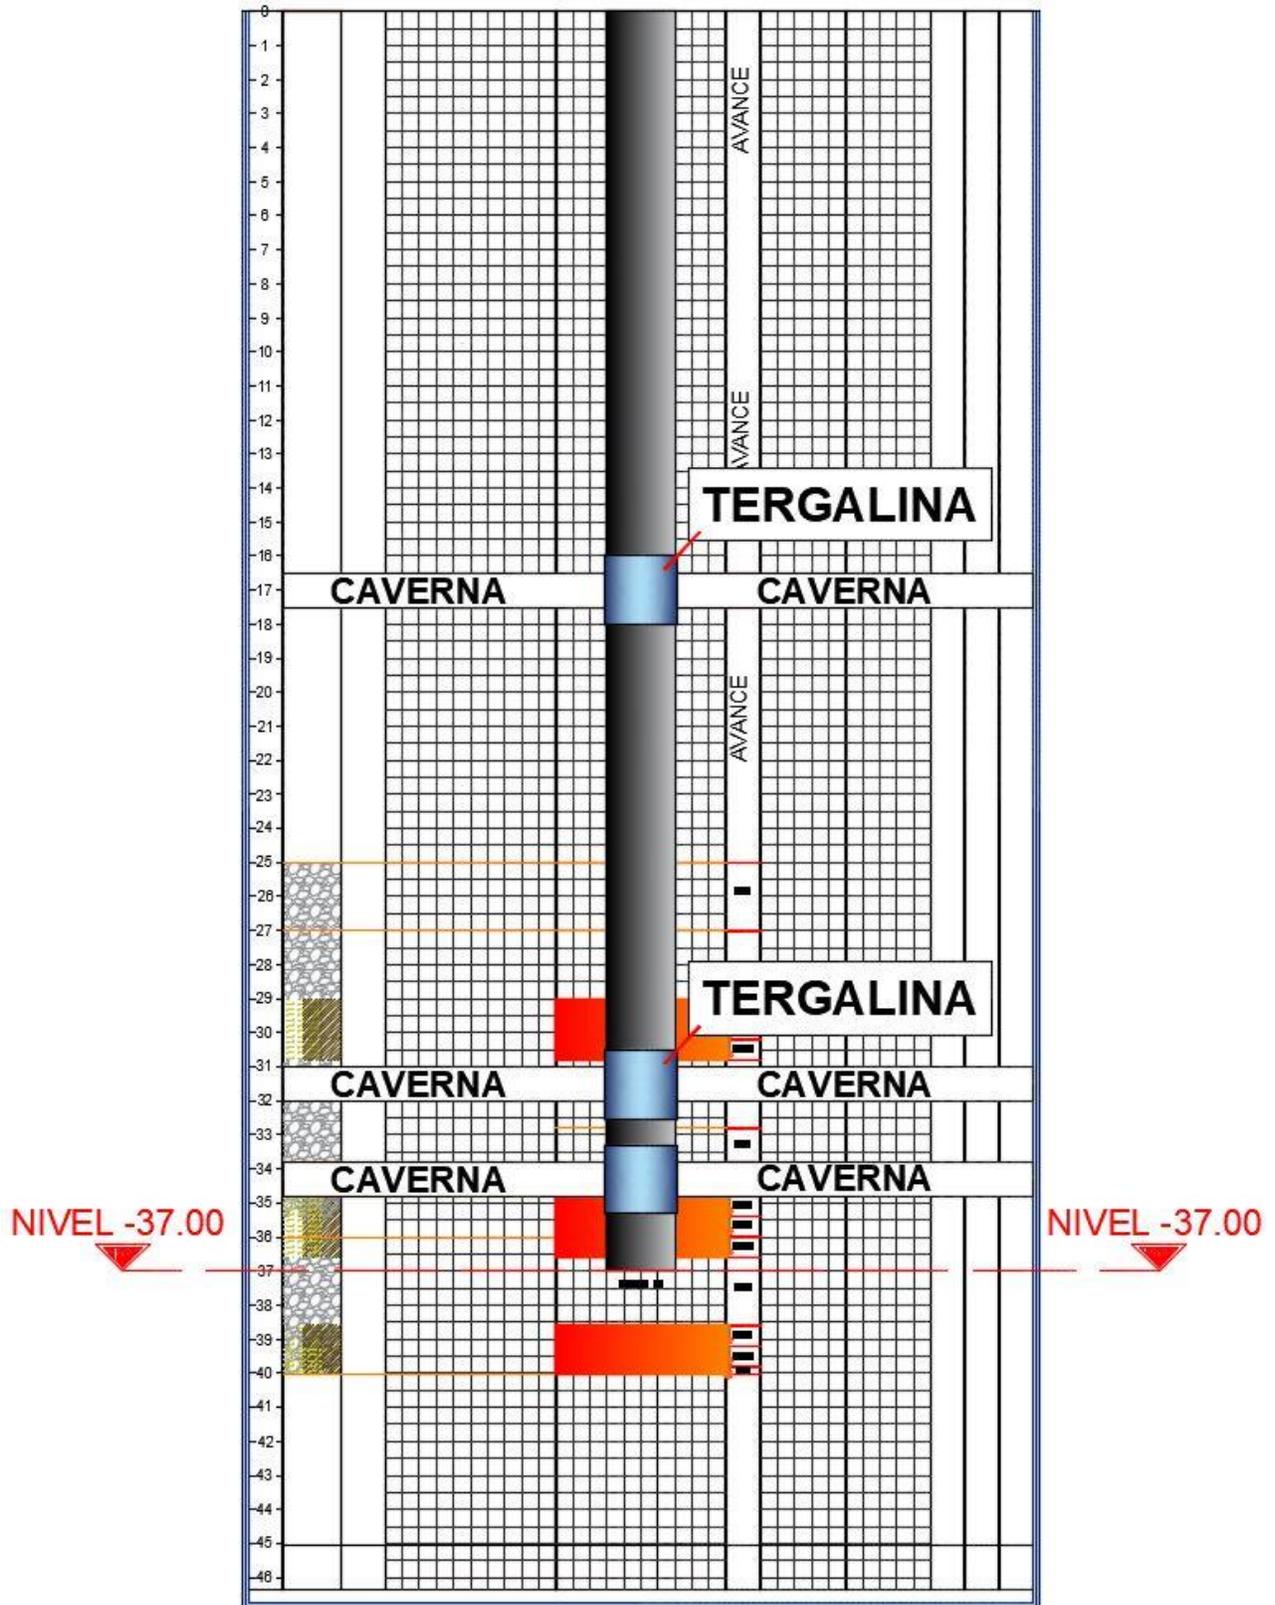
PILA 17 (SM-17 EJE F5).
